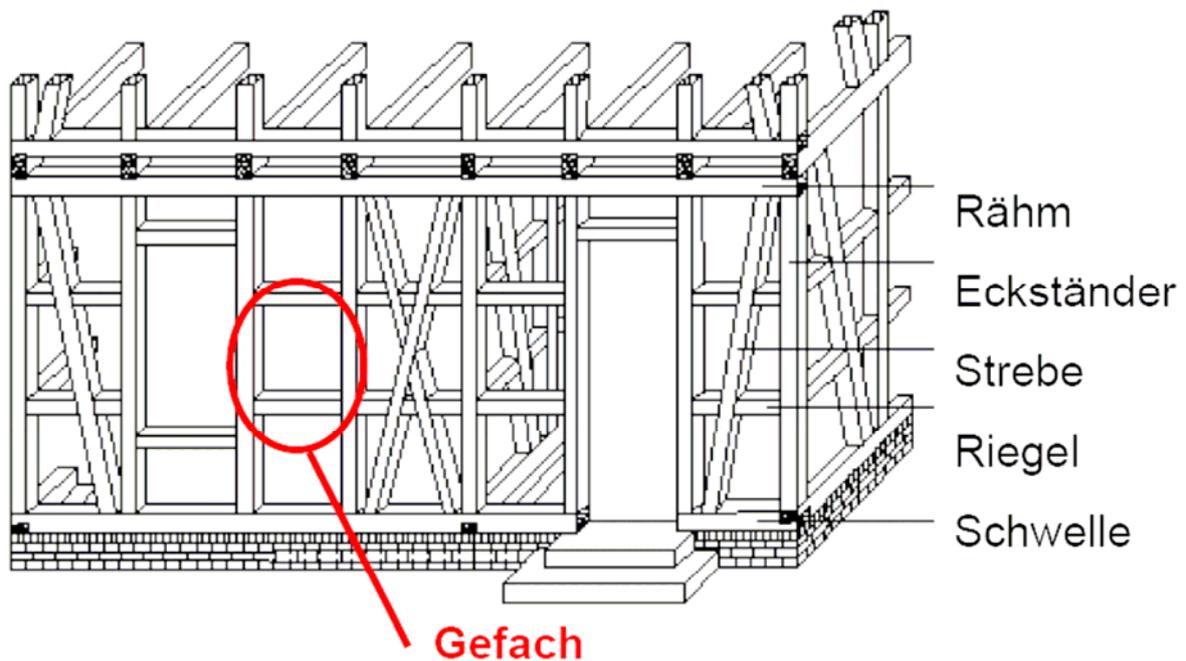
Prinzipskizze mit Darstellung eines historischen Fachwerks mit Bezeichnungen
